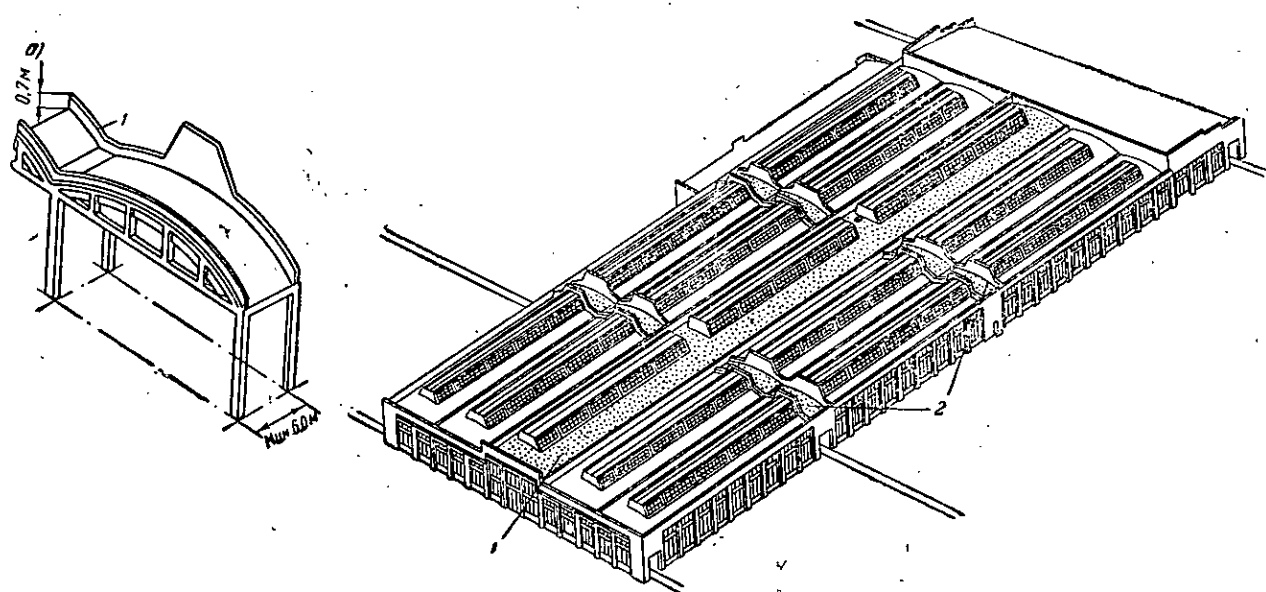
Общий вид здания с продольными (1) и поперечными (2) противопожарными зонами:
